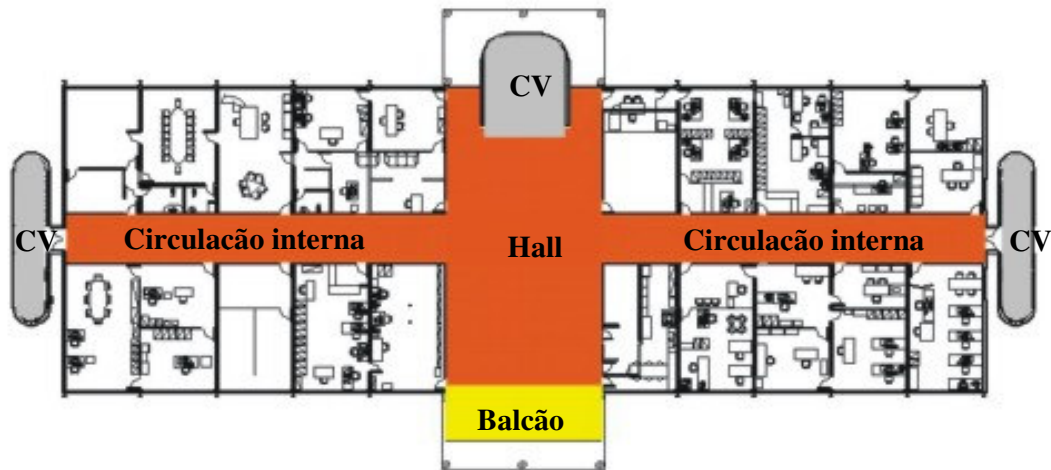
Diagrama da Circulação – Segundo Pavimento – Planta Baixa. (CV – Circulação vertical).
